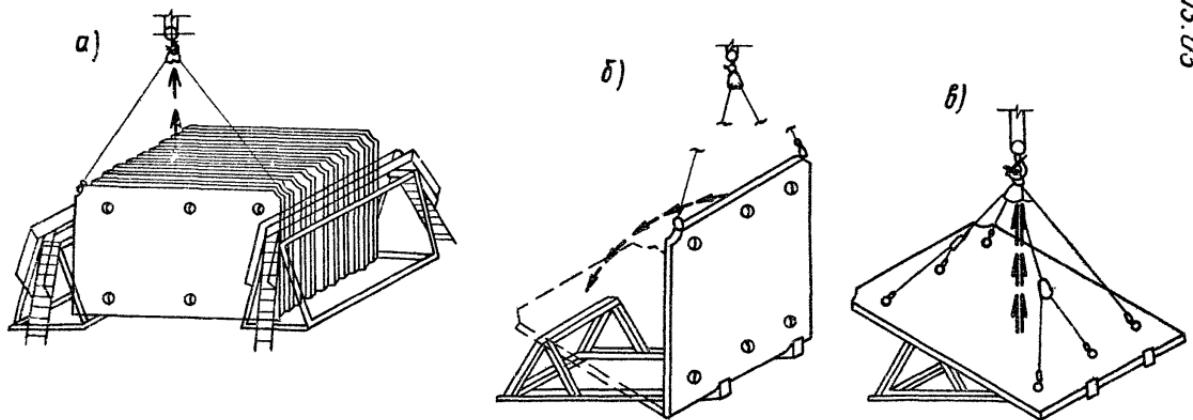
Последовательность нерестроповки панелей перекрытия: а-подъем панели перекрытия из кассеты; б-контование панели перекрытия; в-перестроповка
